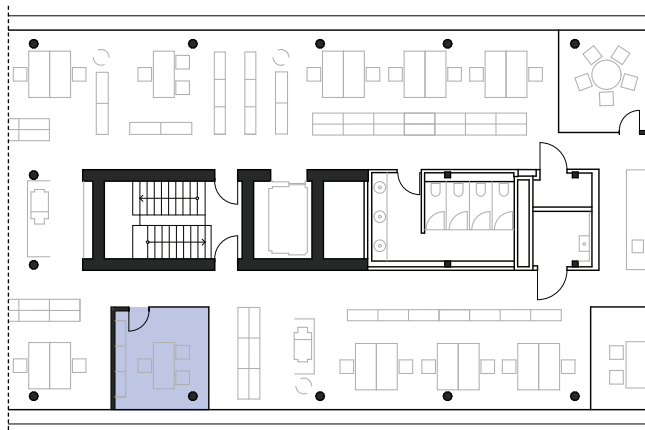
Grundrissausschnitt der Hauptverwaltung der Welthandelsorganisation WTO
